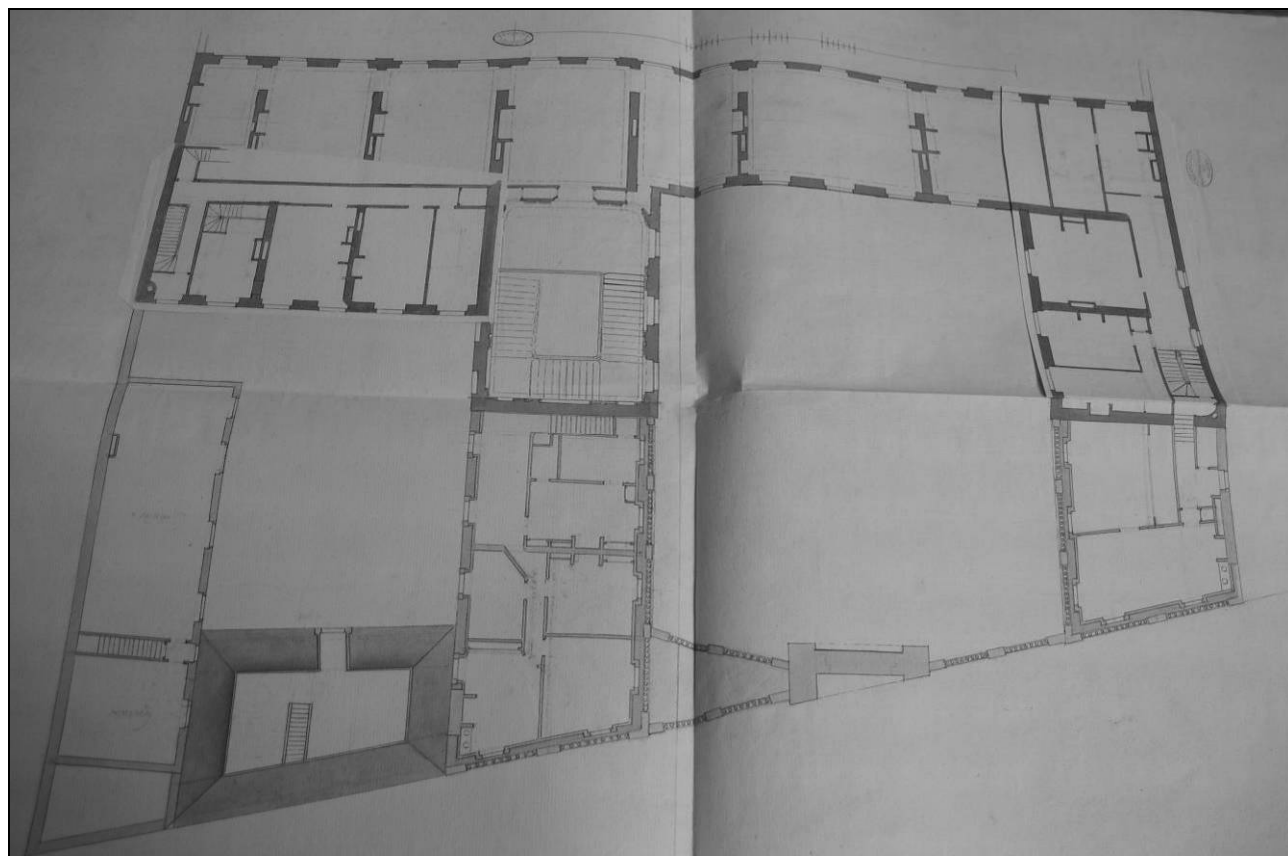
Plan des entresols au-dessus du rez-de-chaussée
